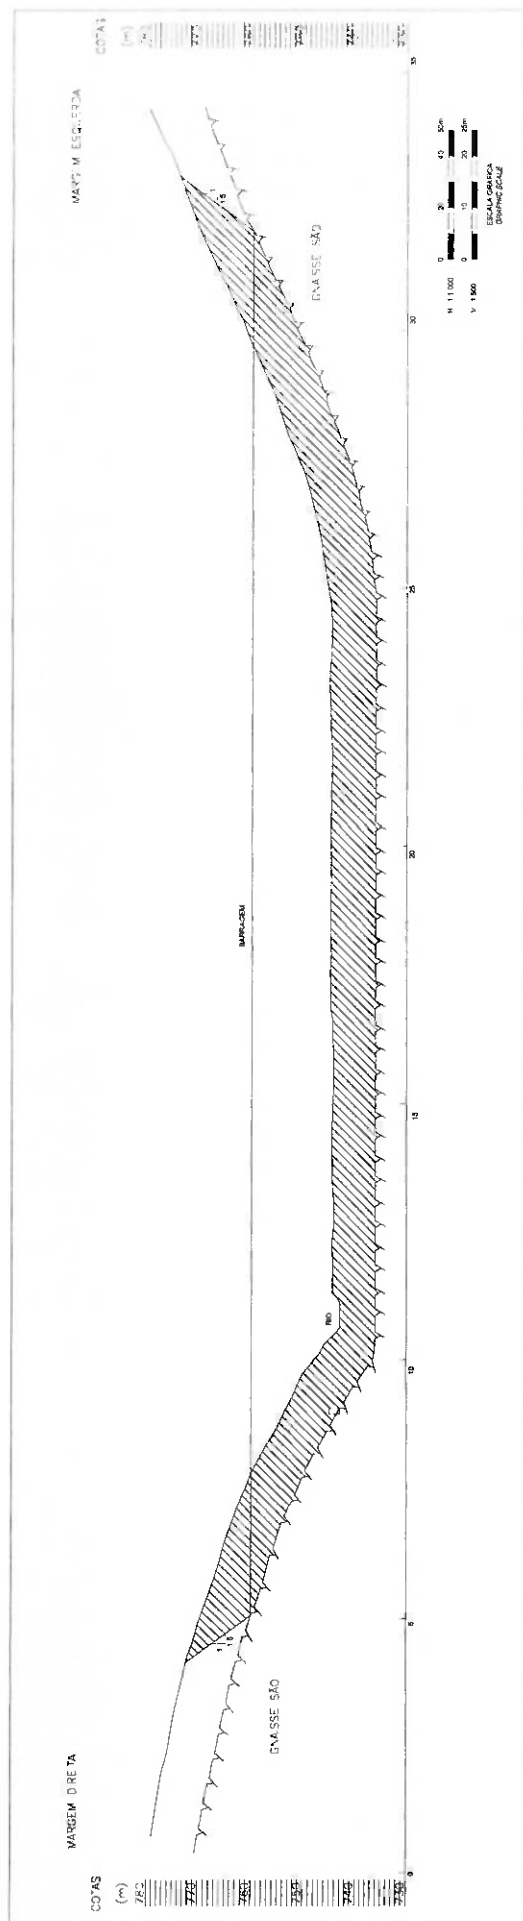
Escavação: corte longitudinal no eixo da barragem
